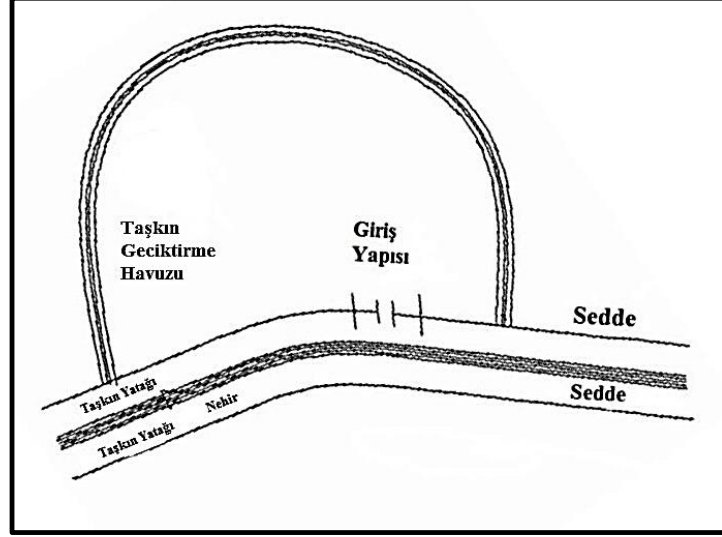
Taşkın kanalı planı (Ağırlioğlu ve Erkek, 1998).
